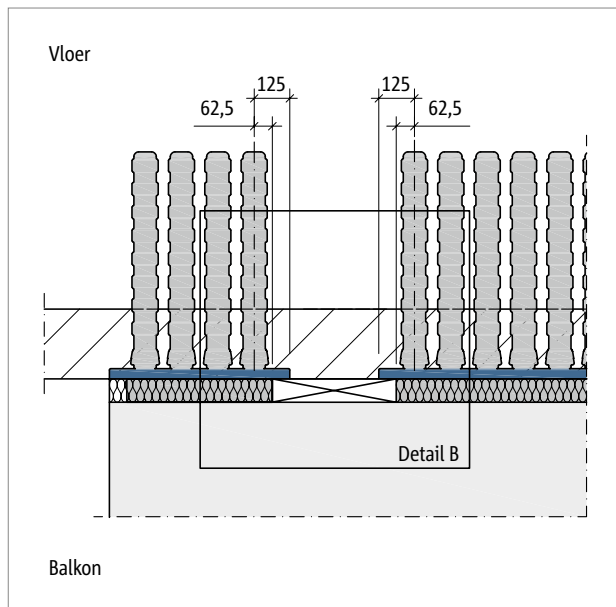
Schöck Isokorf® T type K-E: detail A, juist door naleving van de rastermaat en de voorgeschreven afstanden
